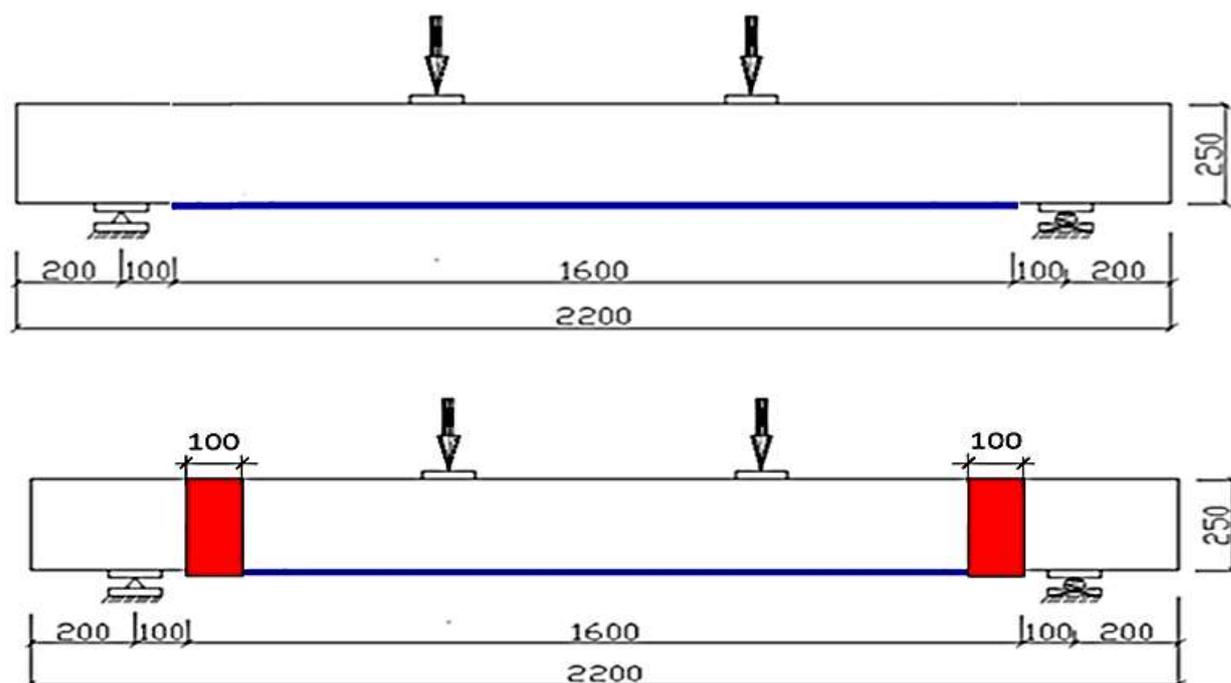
Схема усиления балок: сверху БС-1, снизу БС-2.
